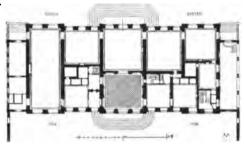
Hôtel de Lassay zu Paris. des Erdgeschosses. Grundriss
